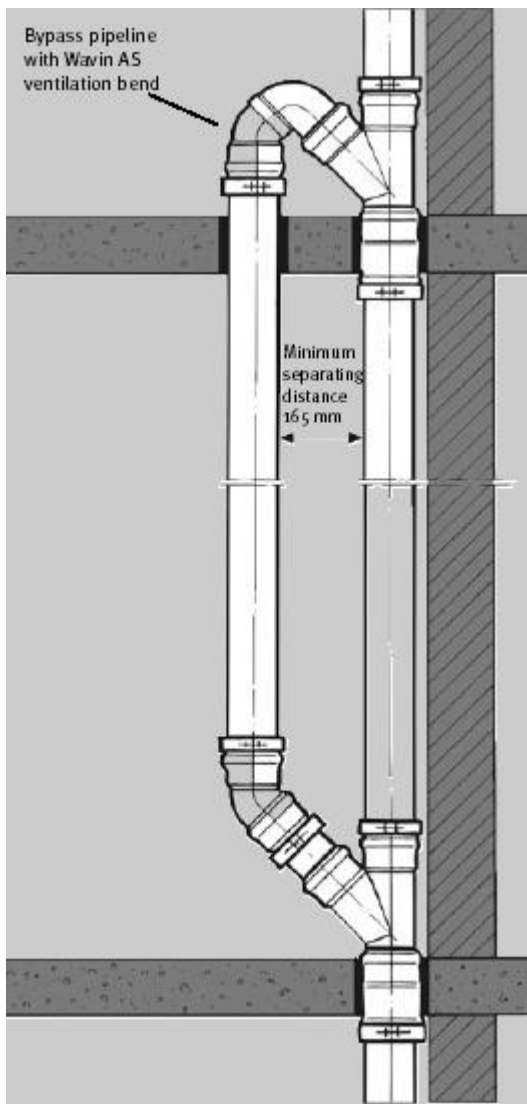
Возвратные вентиляционные трубопроводы с соответствующим коленным переходником Wavin AS
